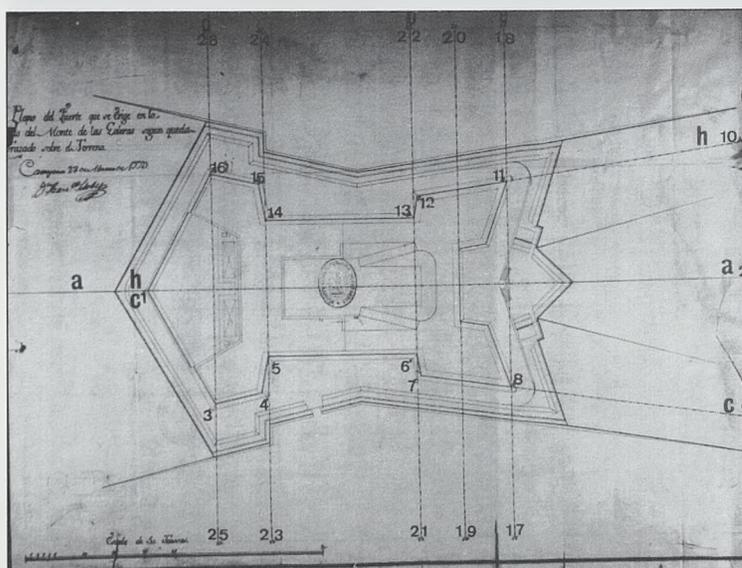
Plano del fuerte que se erige en lo alto del monte de las Galeras, según queda trazado sobre el terreno: Planta y Perfiles, F.LLOBET, Cartagena 23.III.1773 (D.63)
